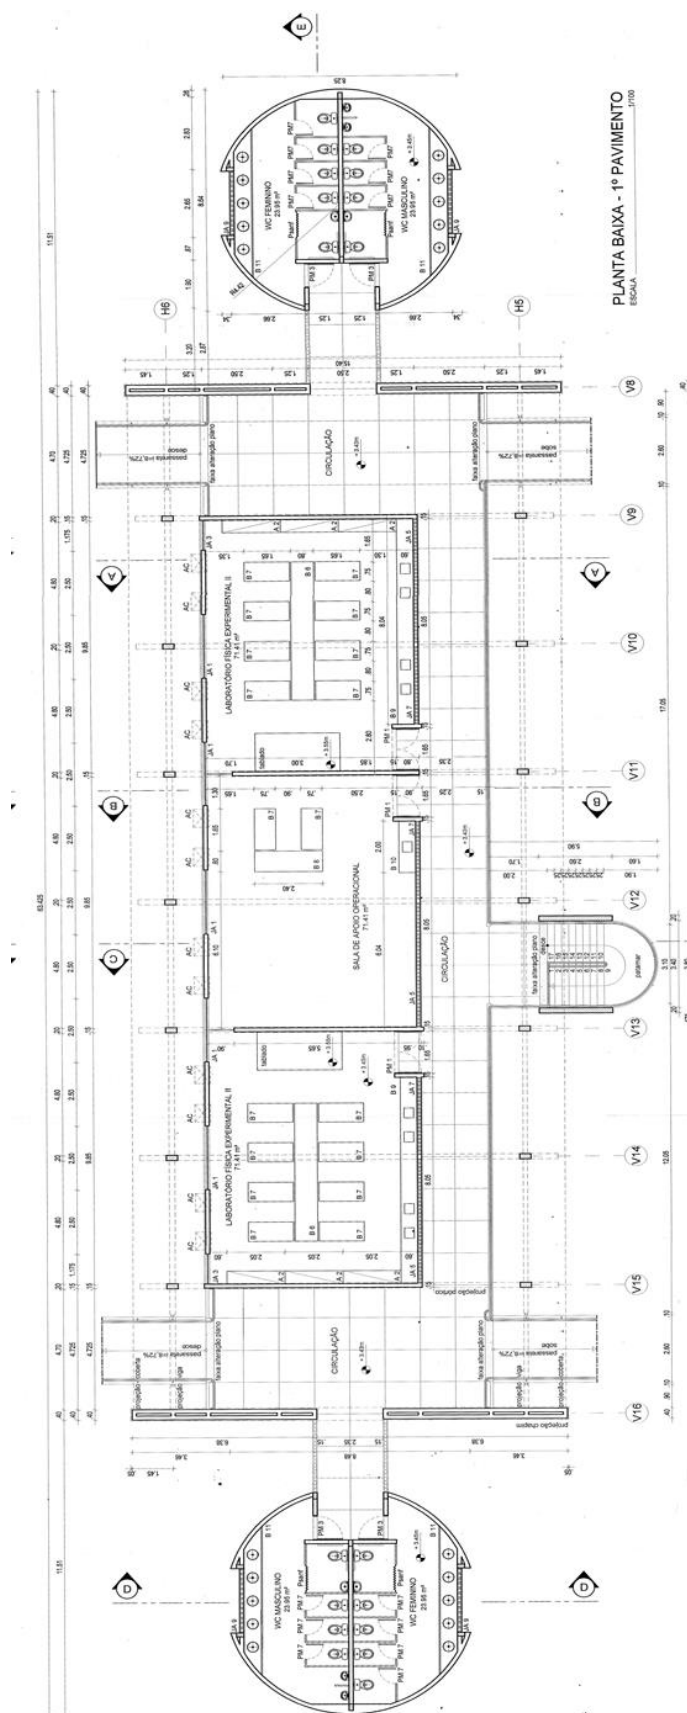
Planta baixa - 1º Pavimento do Bloco 4
